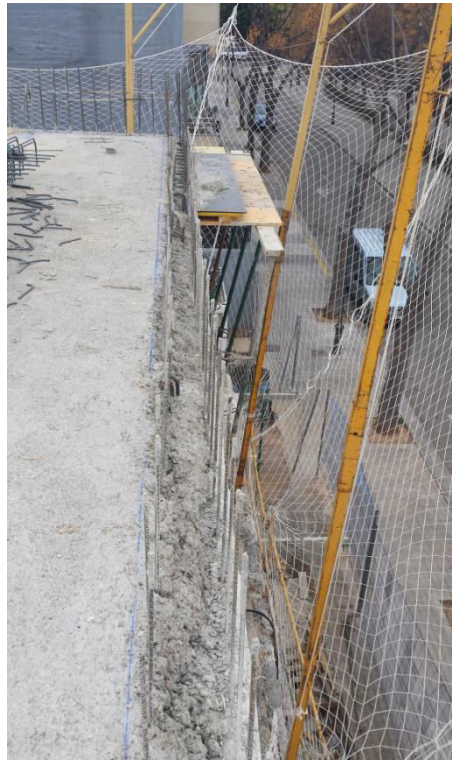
Visualización de las esperas y replanteo de muros de fachada norte
